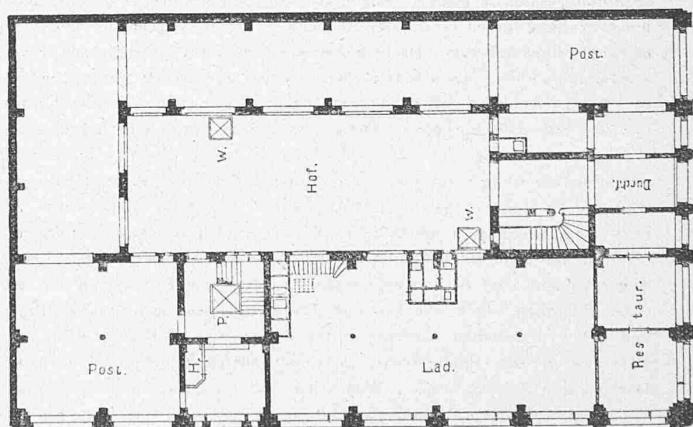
Erdgeschoss-Grundriss vom Kaufhaus Joseph in Berlin. 1:400.
